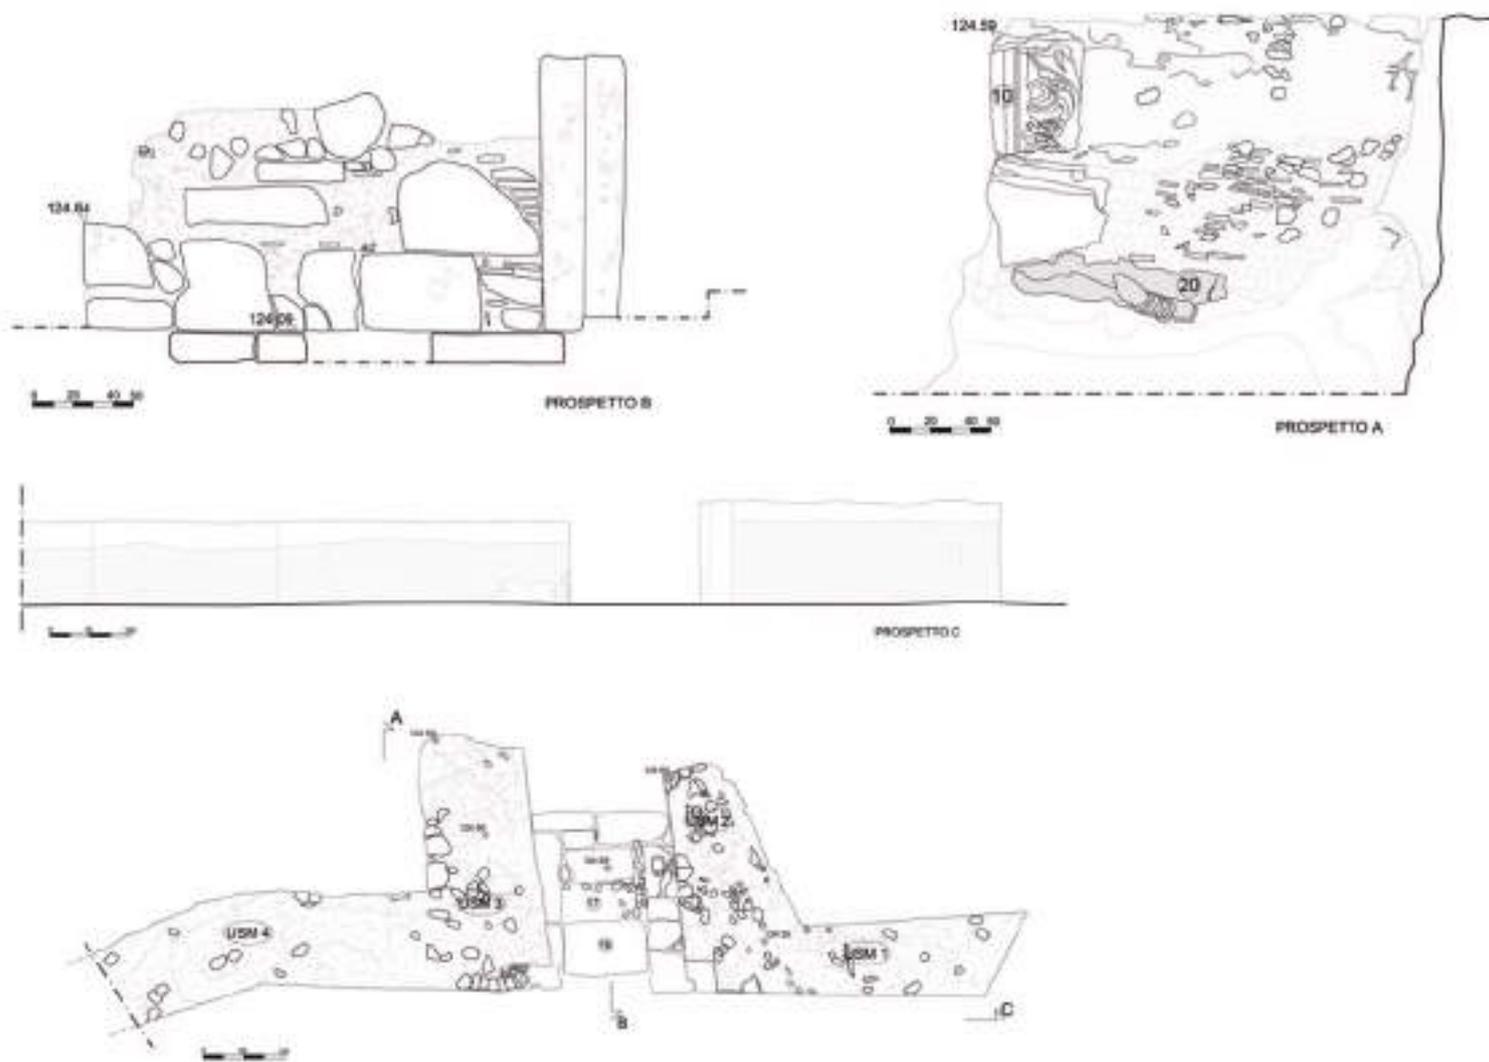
Planimetria e prospetti dei resti del mulino (rilievi ArcheoServizi).
